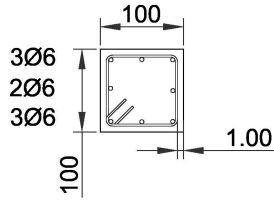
Armado de la viga de HA sin muesca. Distancias en mm.
